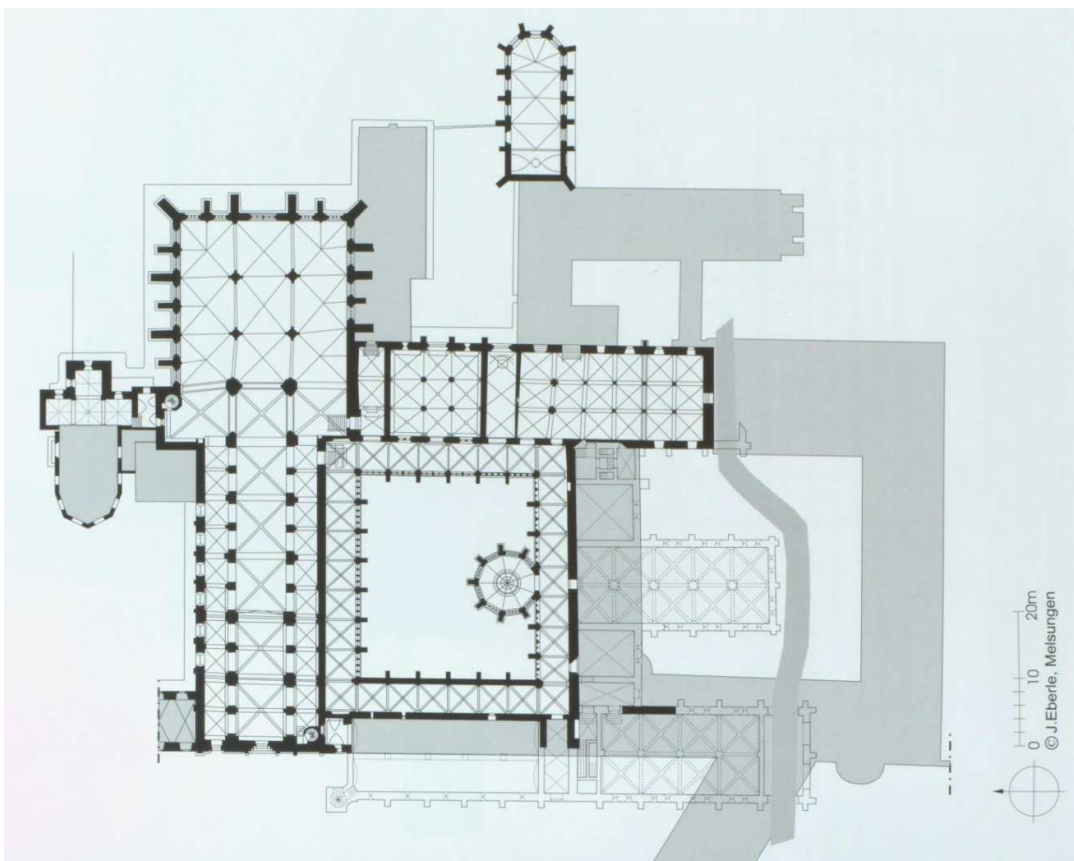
Stift Heiligenkreuz, Grundriss
